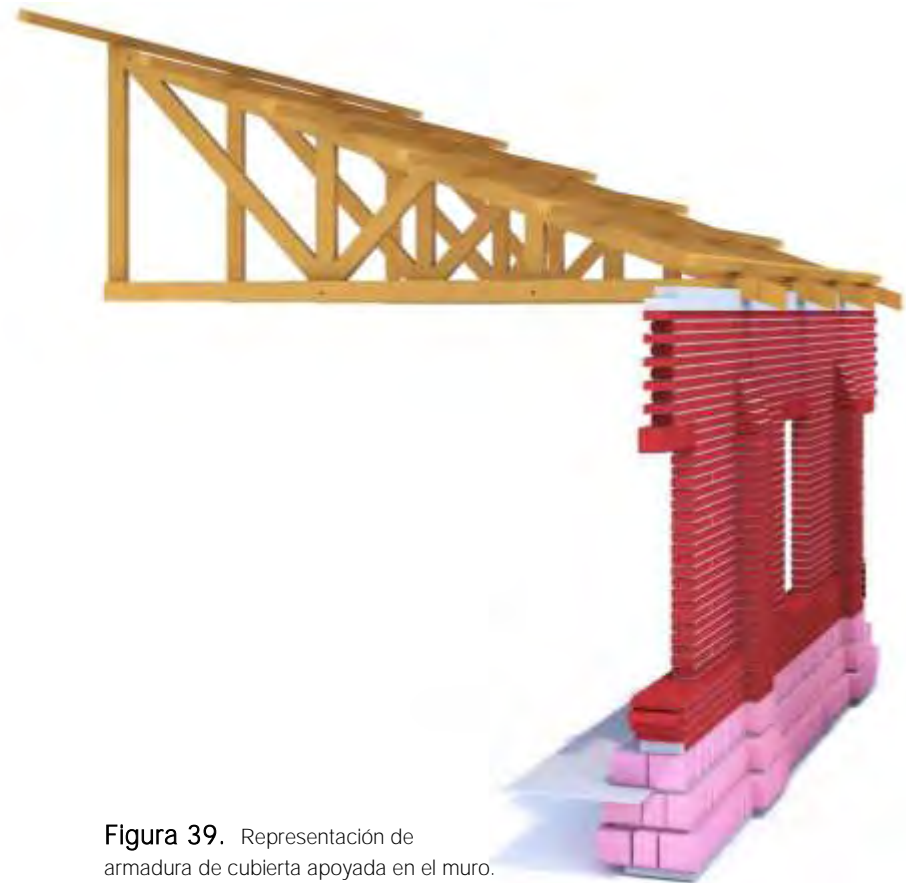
Representación de armadura de cubierta apoyada en el muro.
